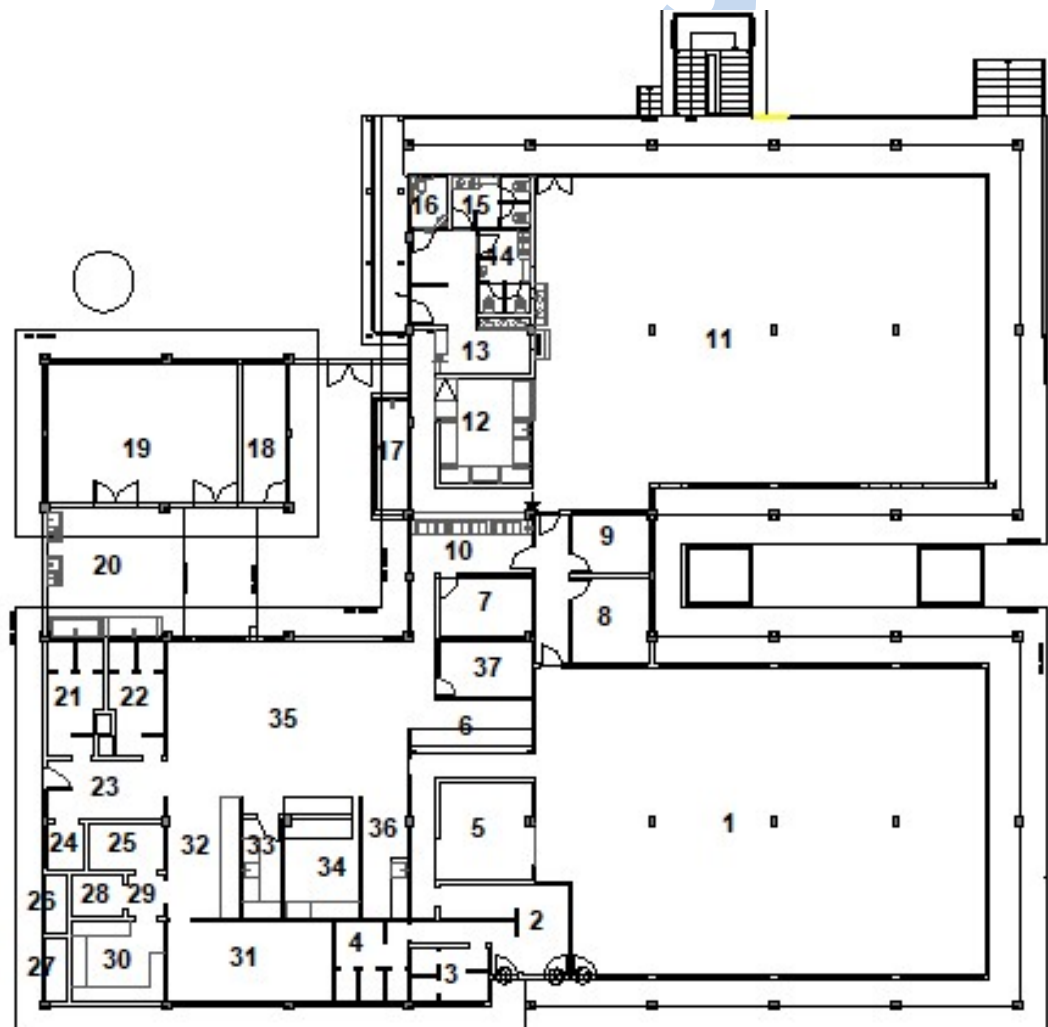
Planta Baixa. RU Campina Grande. Fonte: PU/UFCG
